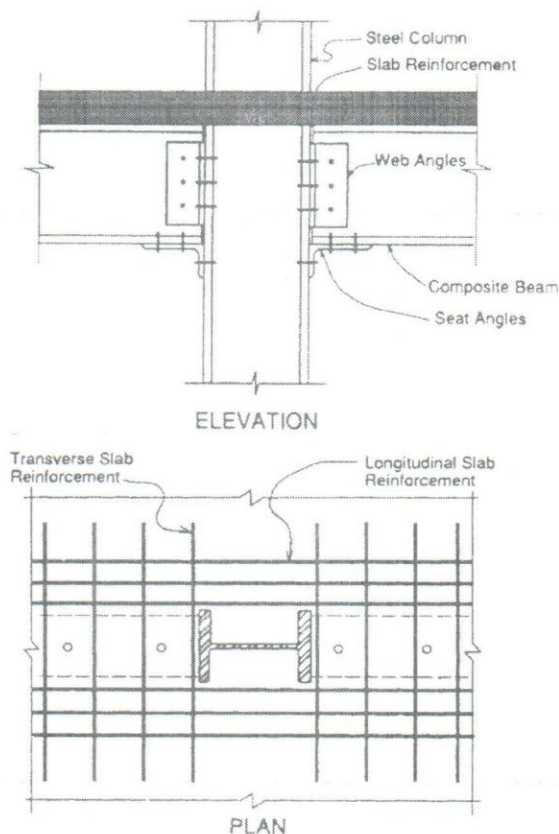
Conexión mixta parcialmente restringida entre losa de concreto y viga de acero²³
